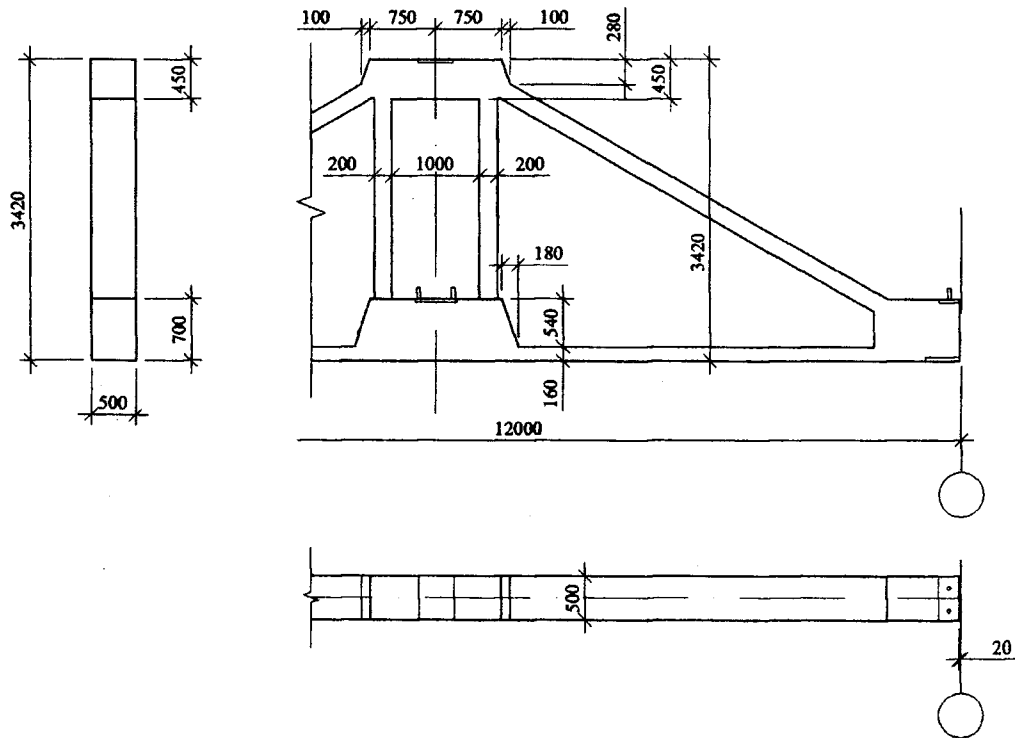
Подстропильные фермы для малоуклонных покрытий
